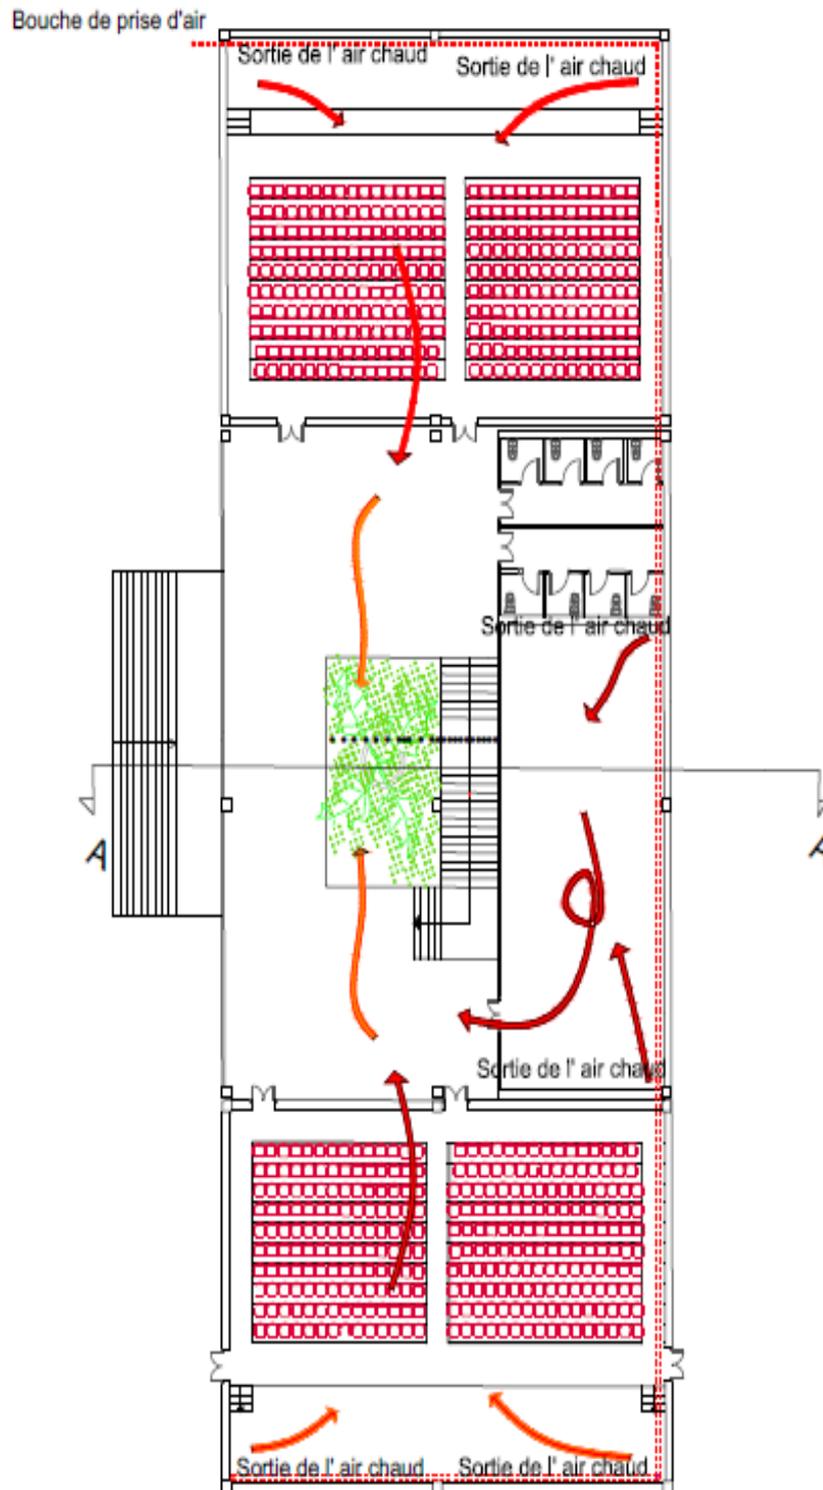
Planschématique du chauffage par puits canadien .Source :Auteurs
